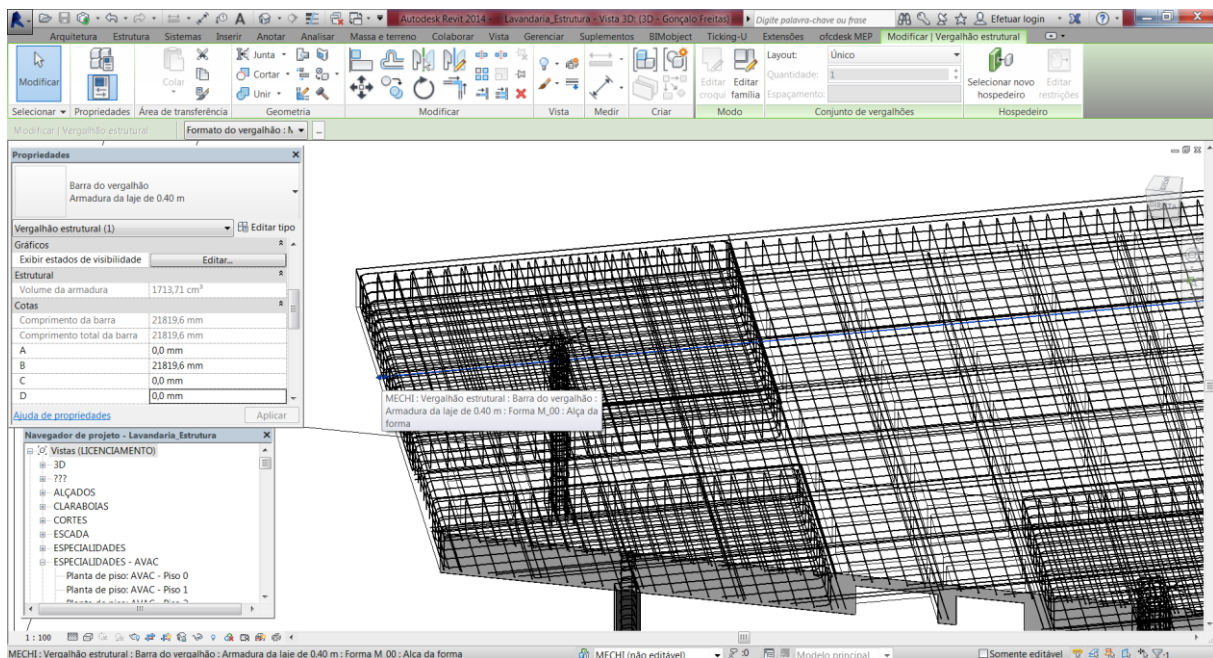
Visualização do “estender” a armadura da laje para o capitel.
